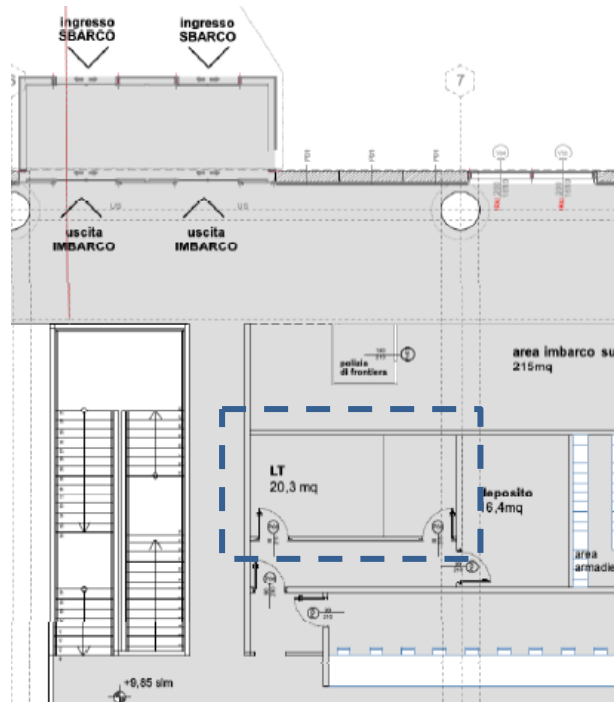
Piano primo, area centrale: locale tecnico (dettaglio)
